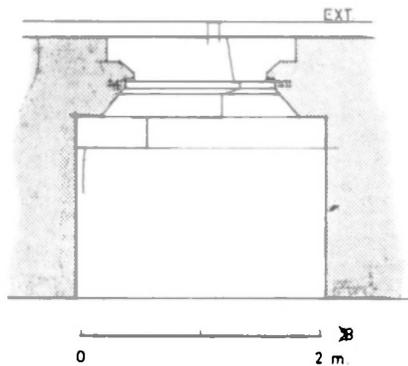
Fenêtre du bas-côté sud : plan et coupe dans le seuil.
